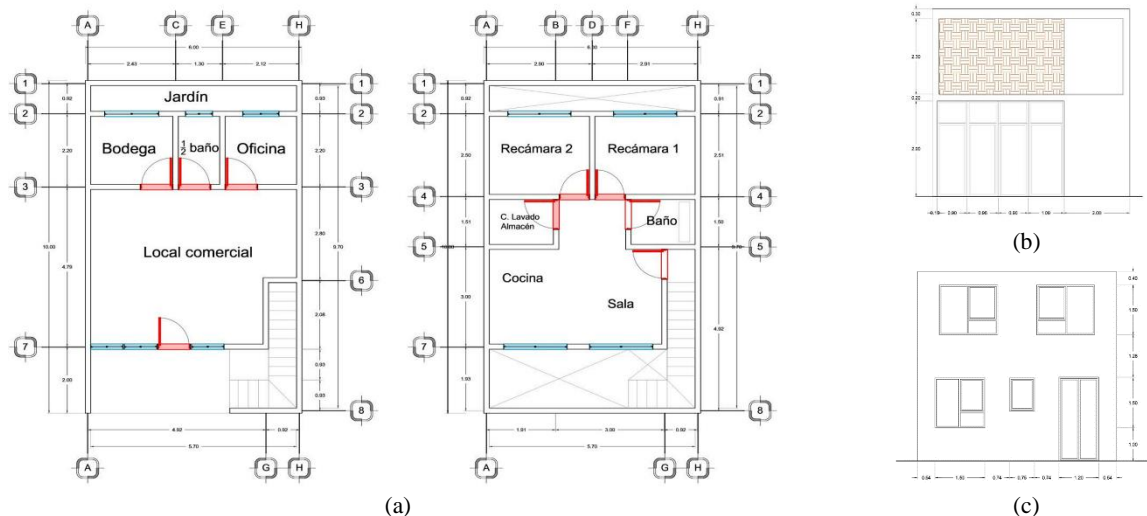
Edificación propuesta. (a) Planta comercial y planta residencial, (b) Fachada frontal, (c) Fachada posterior.
